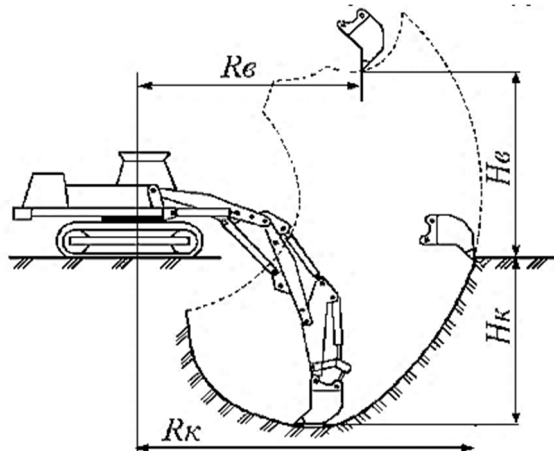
Схеми робочих параметрів одноківшового екскаватора з робочим обладнанням зворотна лопата:
